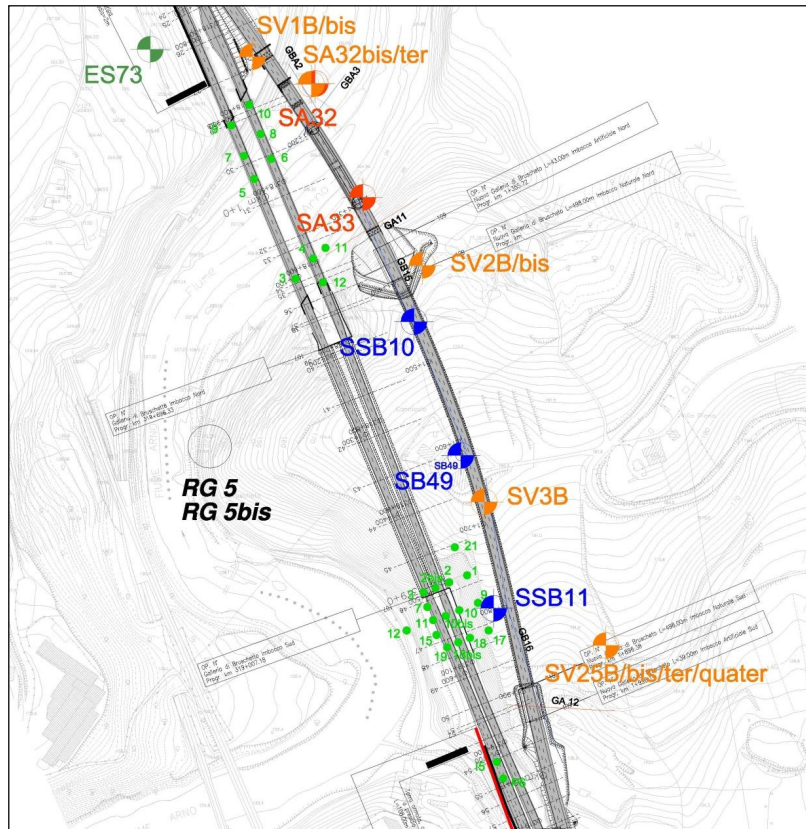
Stralcio planimetria generale con ubicazione indagini eseguite per la Galleria Bruschetto
